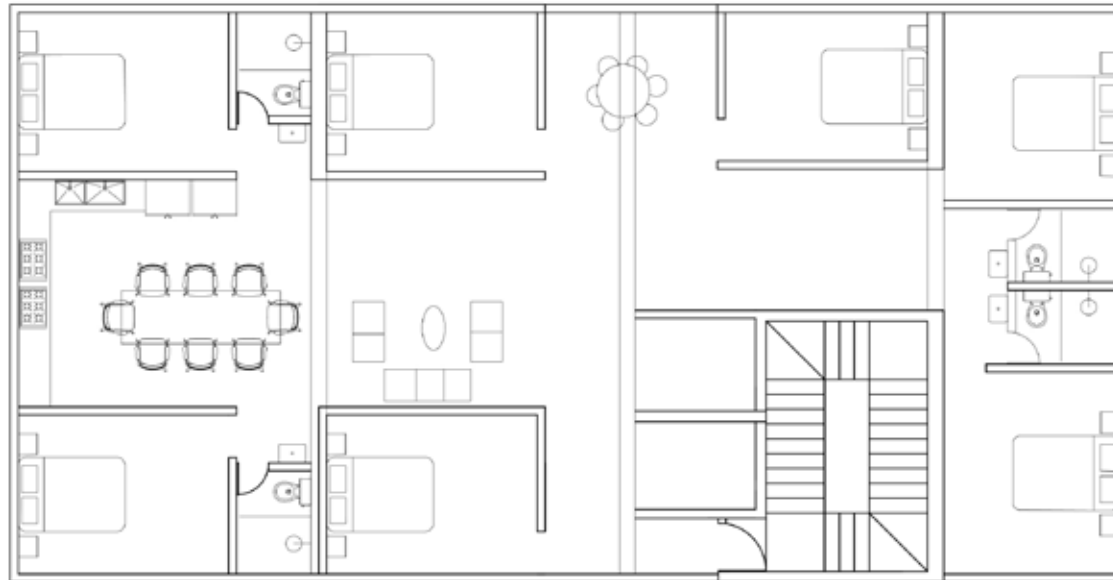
Planta de um pavimento tipo da proposta reduzido devido aos afastamentos laterais e de fundos.
